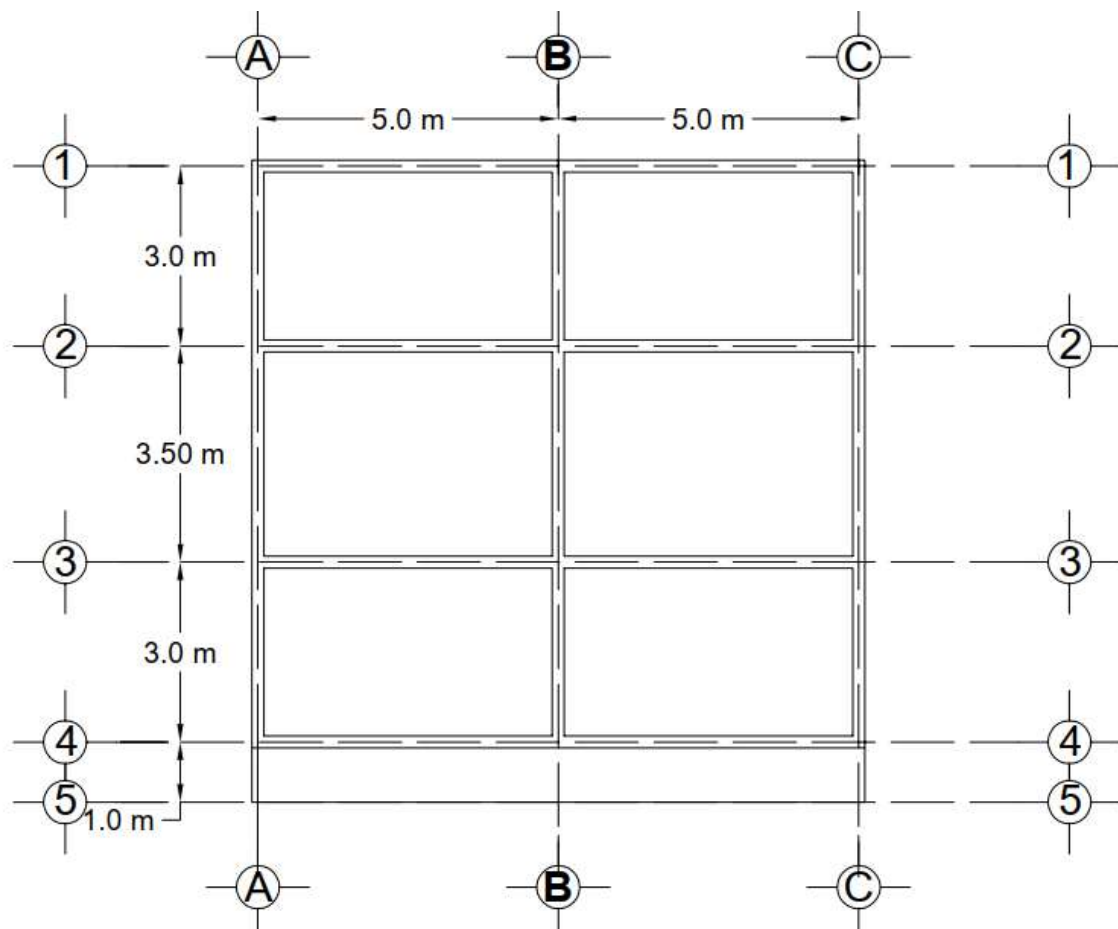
Distribución de los tableros de la losa, vigueta y bovedilla.
